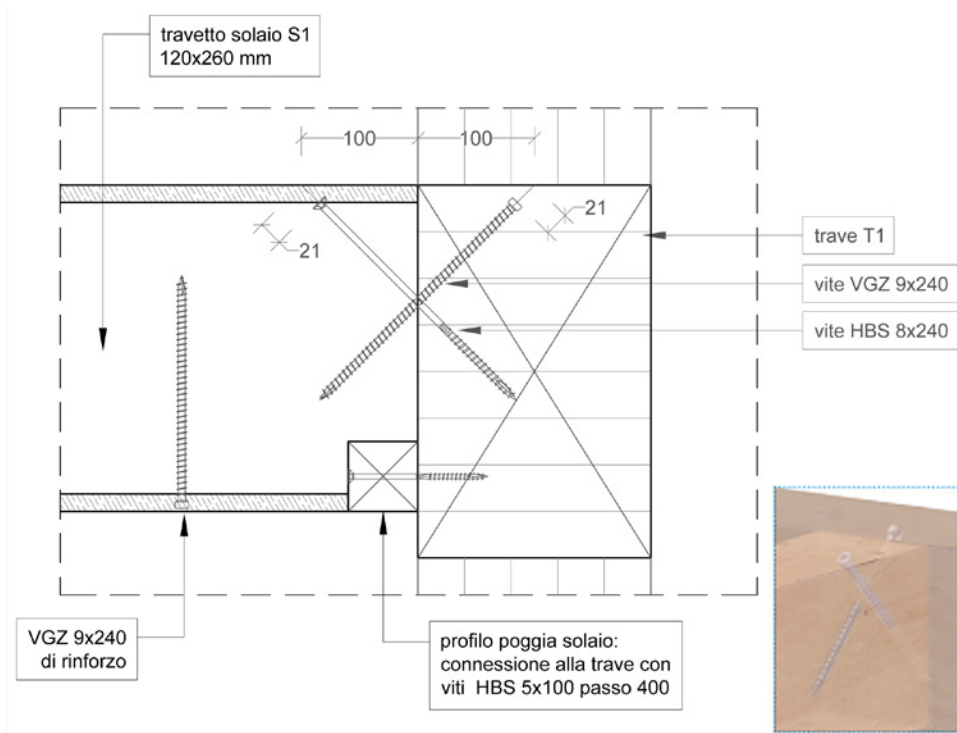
Dettaglio strutturale – connessione con viti inclinate a 45°
